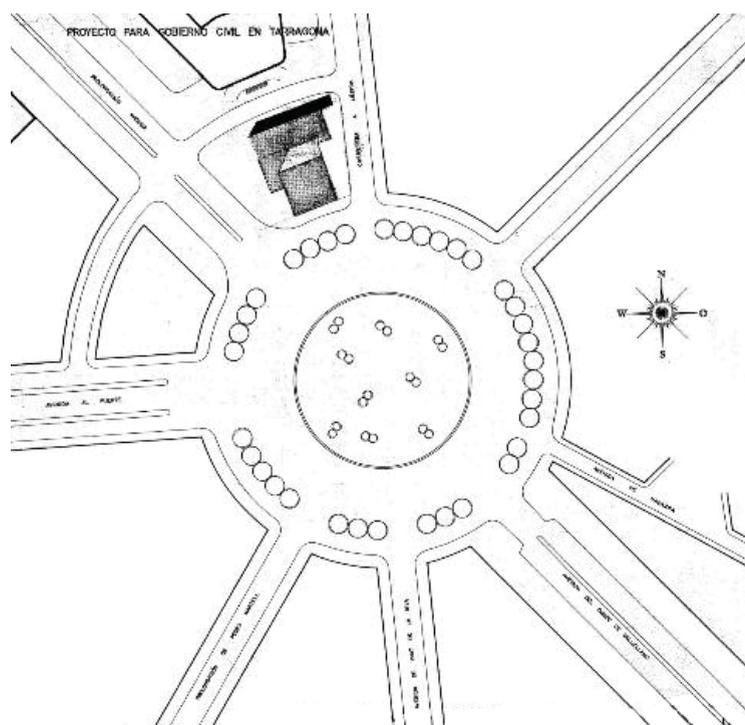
Planta de situación, proyecto de ejecución. Fundación Alejandro de la Sota.
